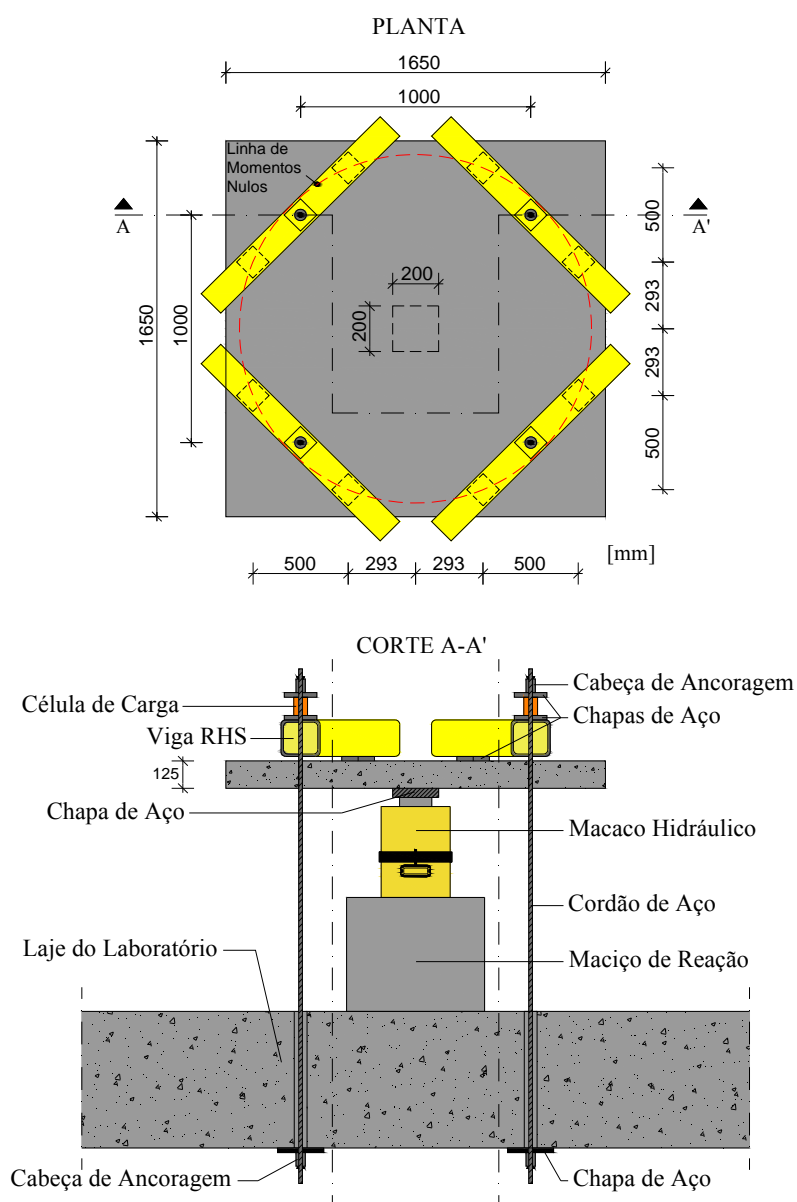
Sistema de ensaio utilizado (dimensões em mm).
